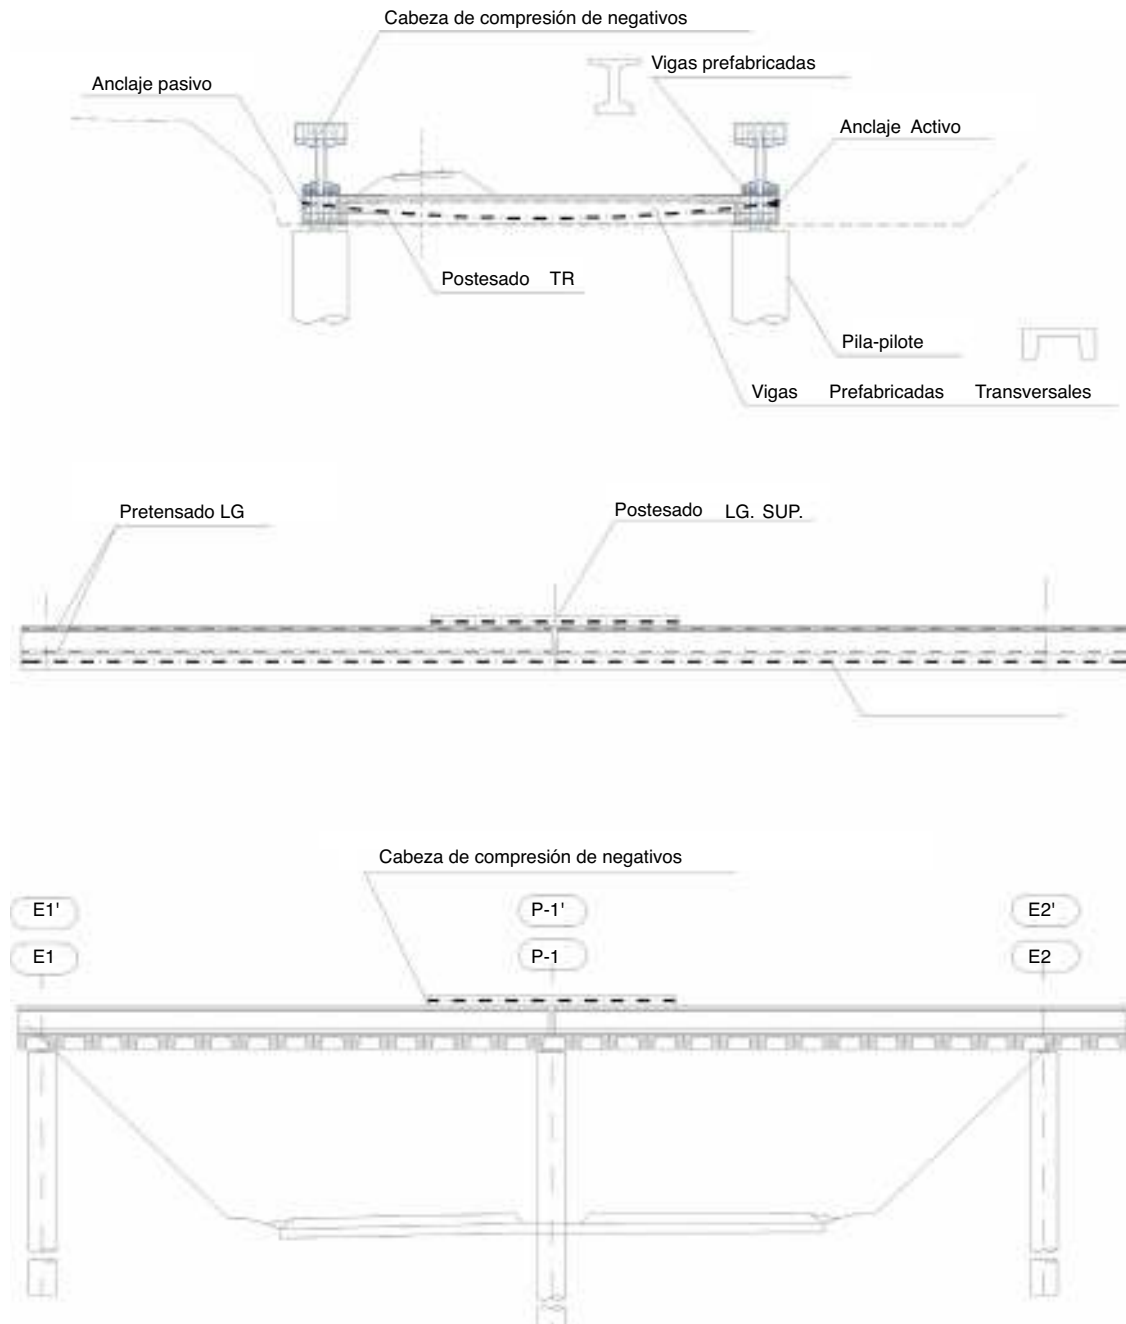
Variante solución 1 con viga longitudinal prefabricada. Esquema conceptual.
